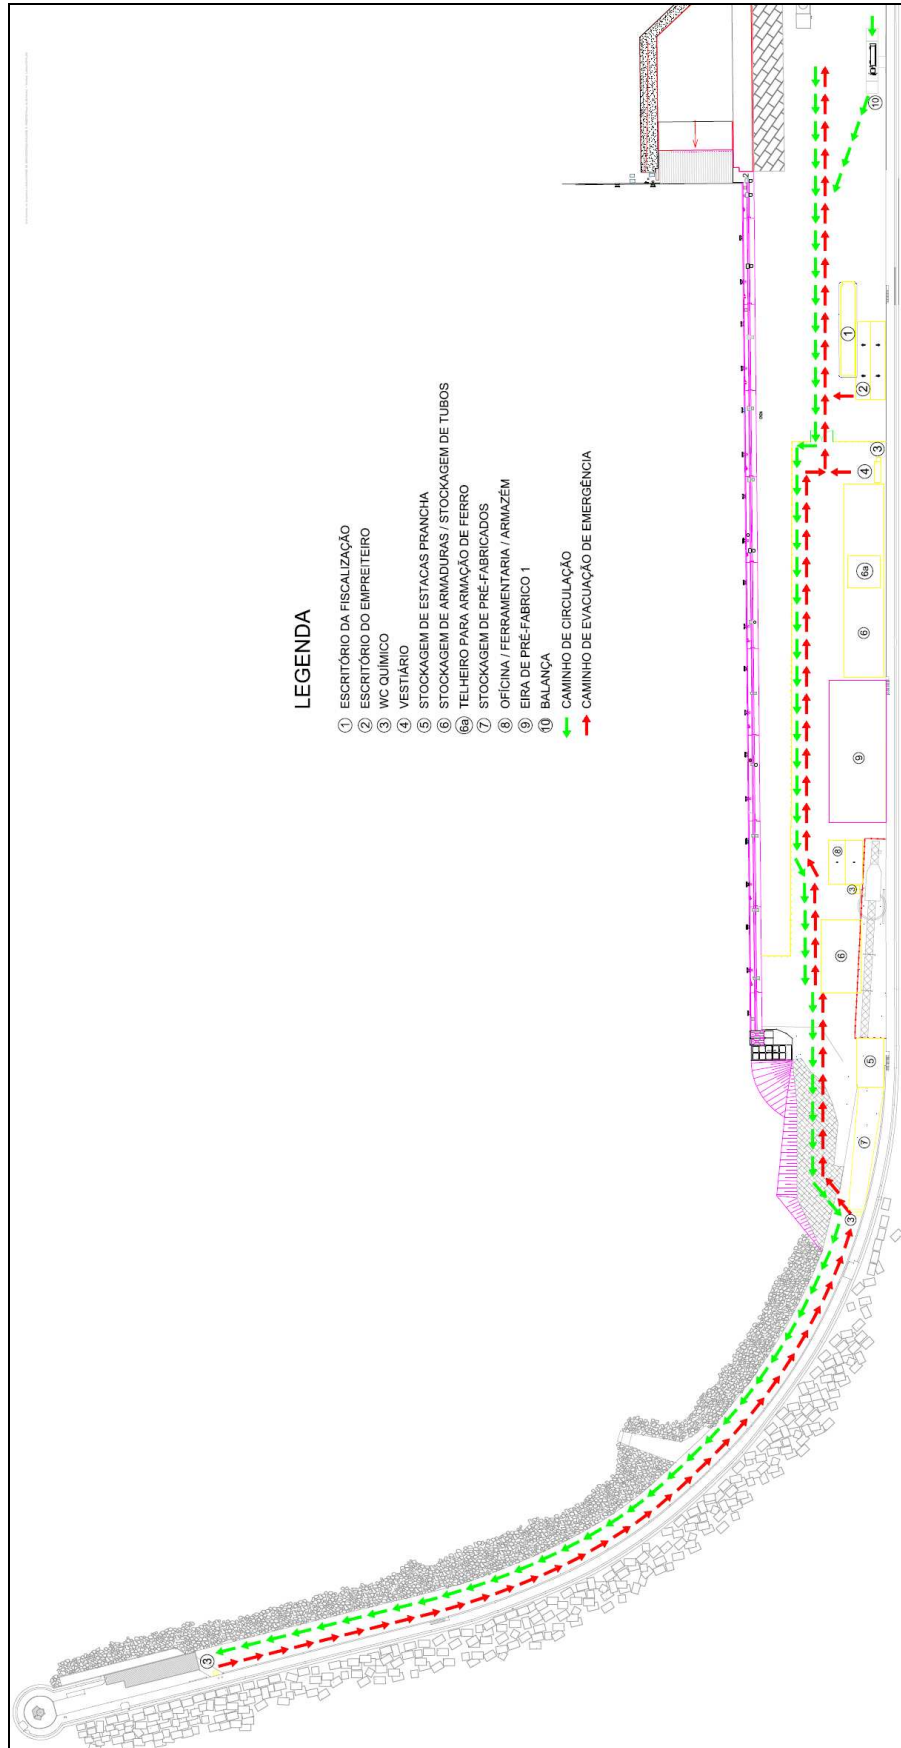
Planta do estaleiro com caminho de circulação e de evacuação de emergência [25].
